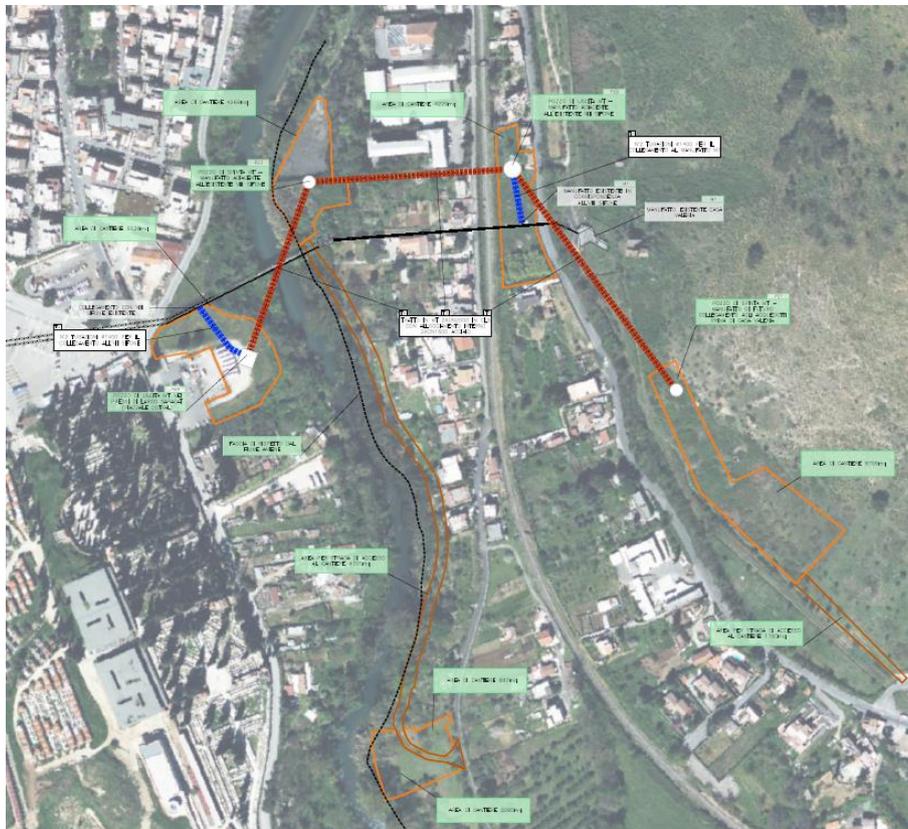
Opere di progetto ed aree di cantiere - Raddoppio VIII Sifone
